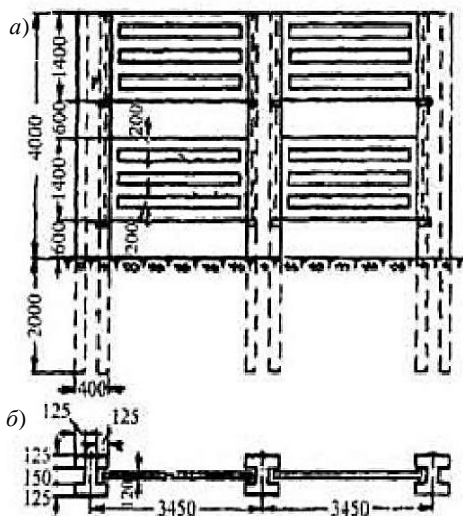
Забор железобетонный снегозадерживающий (размеры даны в мм):
